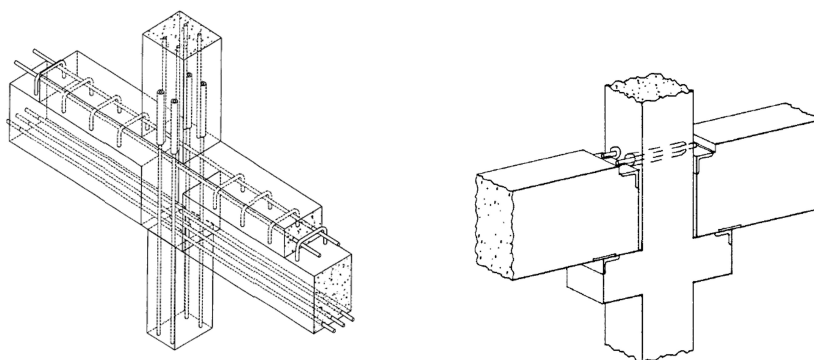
Exemplos de ligação viga-pilar com continuidade, com armaduras e betonagem *in situ* (esquerda) e com chapas aparafusadas e consola curta (direita). Adaptado de [1].
